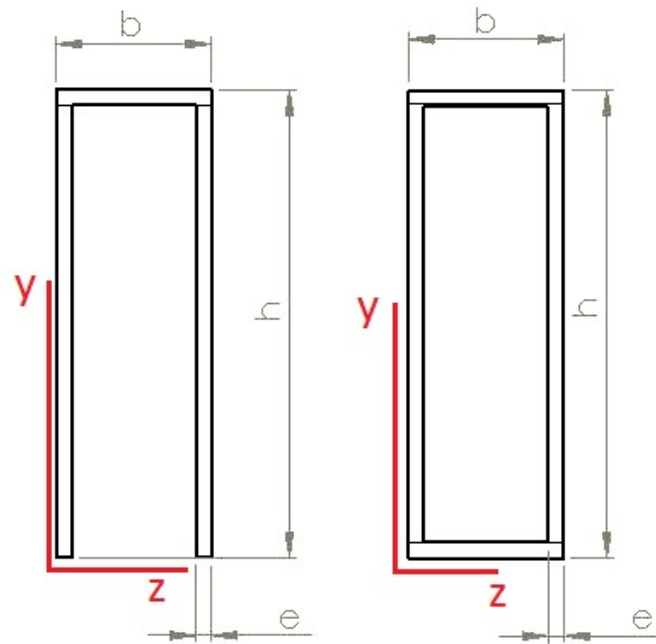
Geometría genérica de viga cajón abierta (izquierda) y cerrada (derecha)
